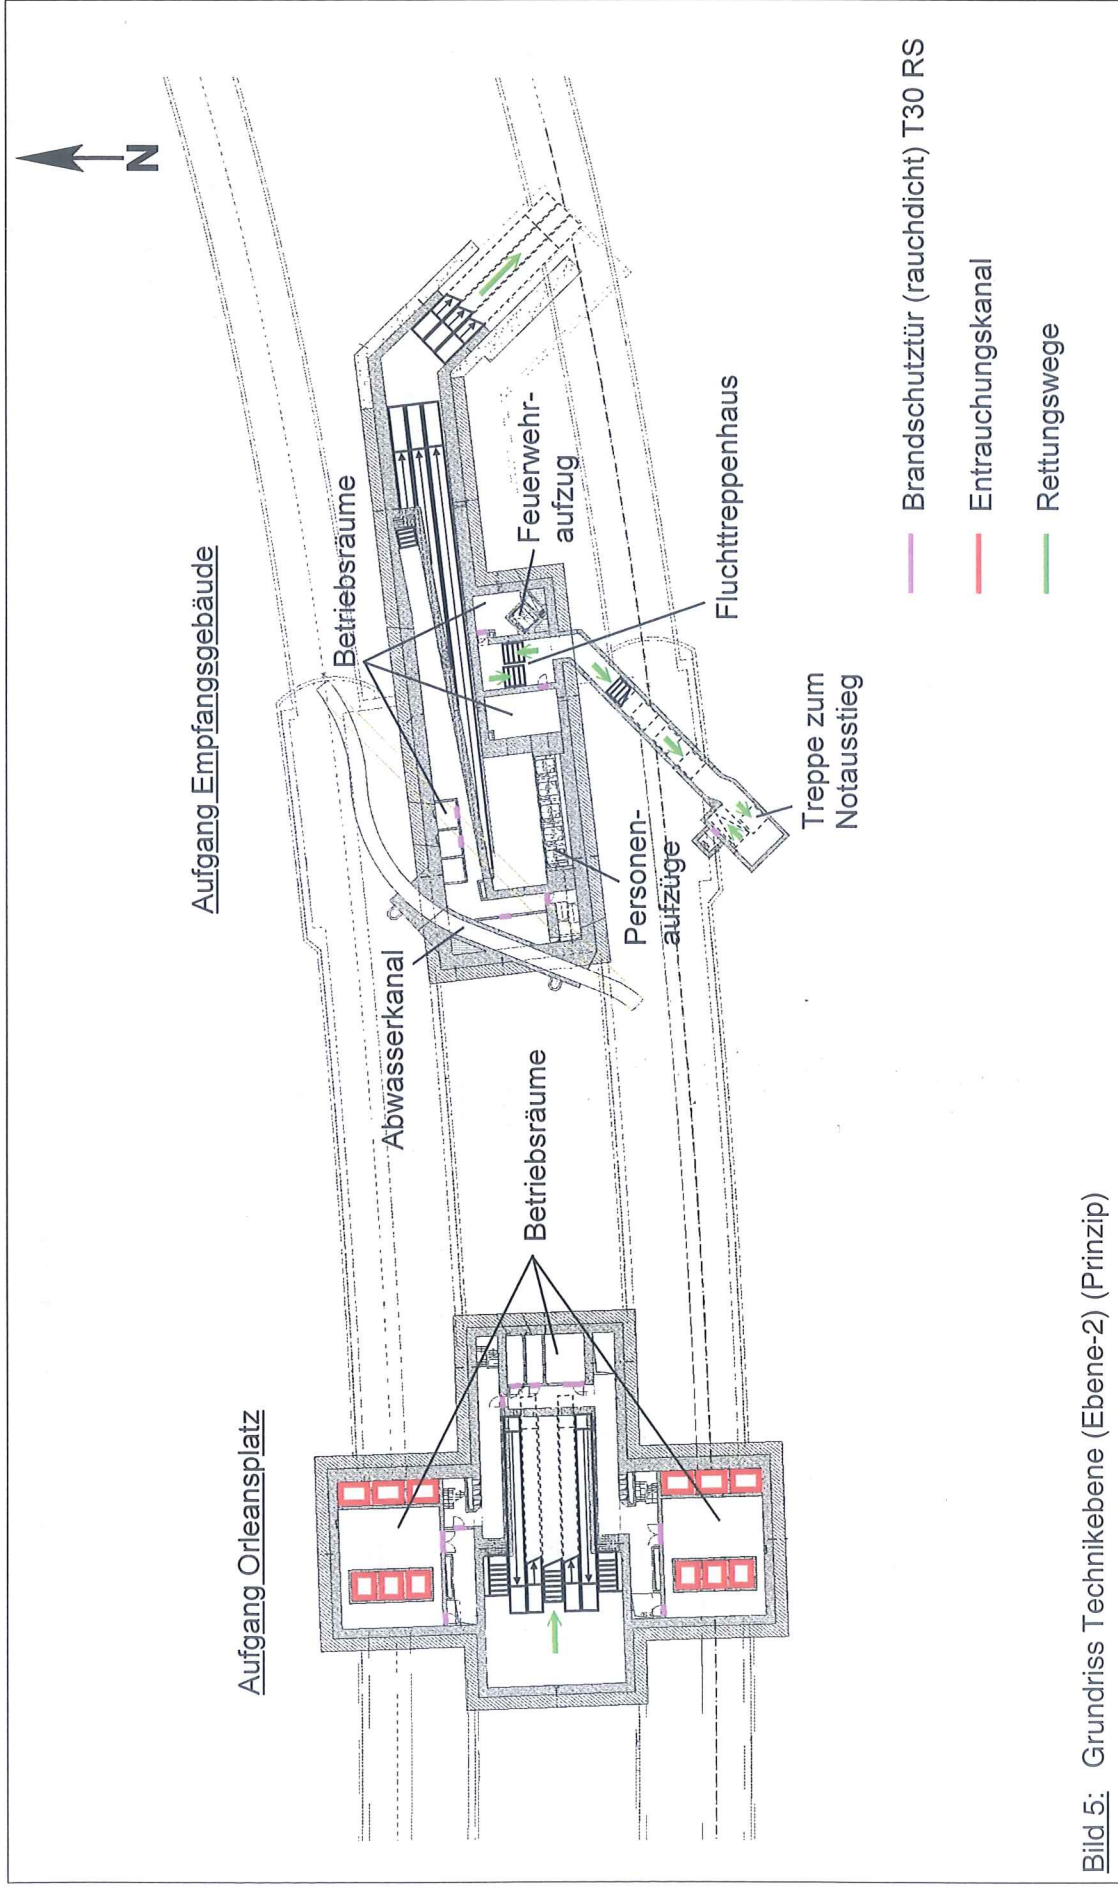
Grundriss Technischebene (Ebene-2) (Prinzip)
